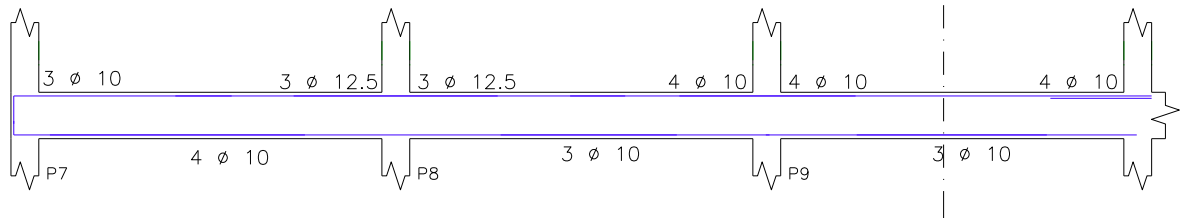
Esquema do dimensionamento à flexão das vigas finais 02/03/04/05/08/09/10/11, pavimentos tipo
